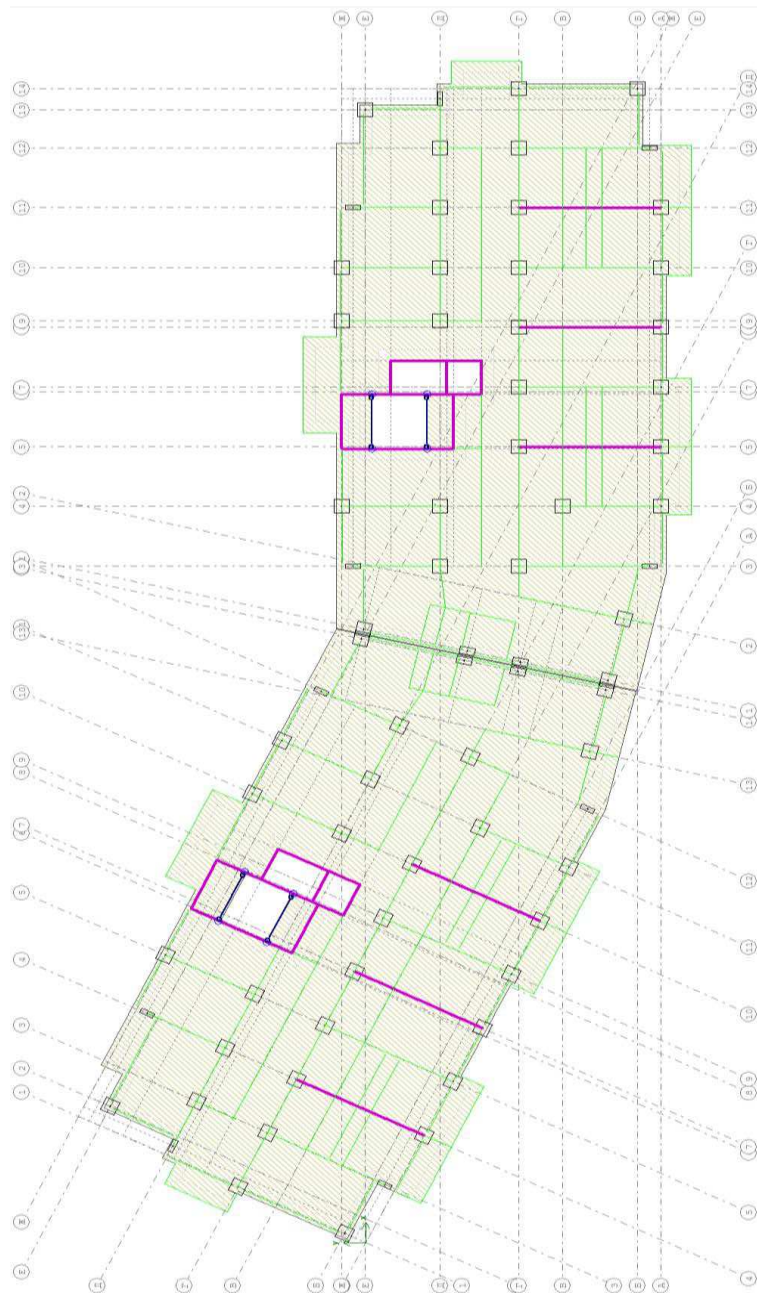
Схема расположения плит перекрытия колонн, диафрагм жесткости и перегородок на типовом этаже
